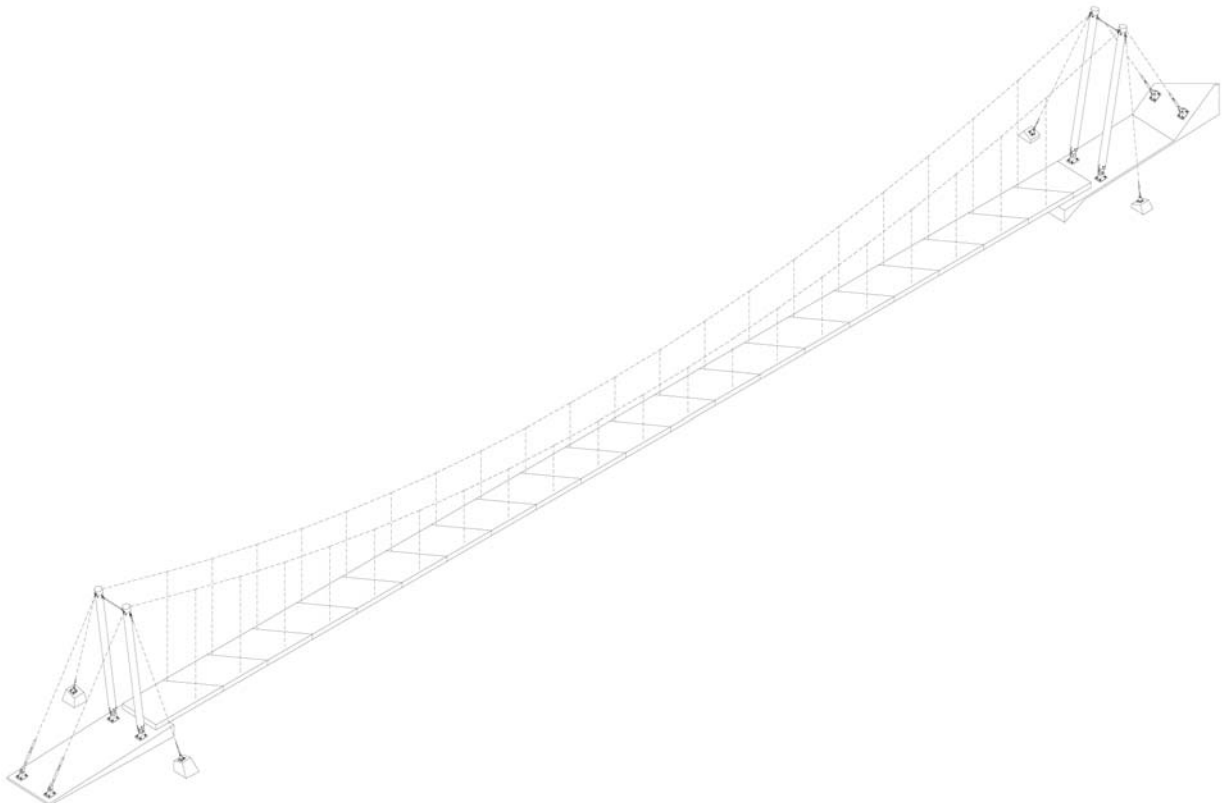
Axonometría con la modulación de elementos prefabricados de tablero
